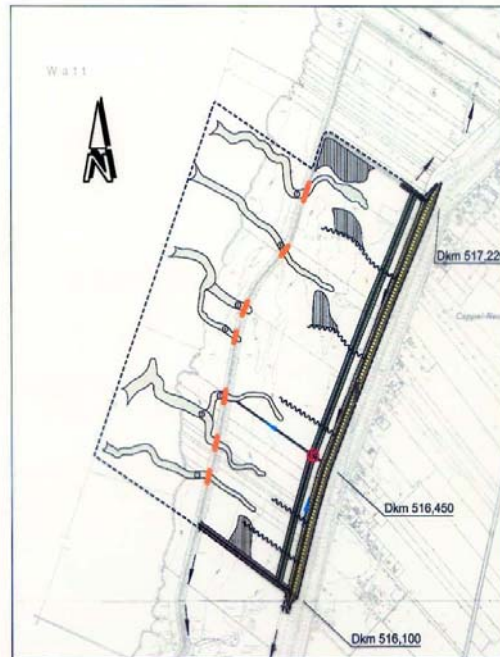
Lageplan bauliche Maßnahmen Wurster Küste
